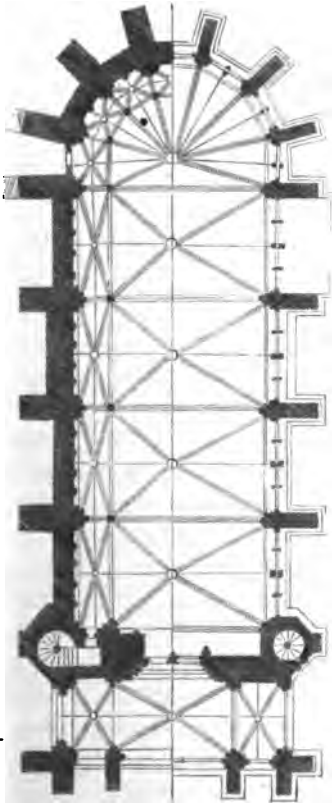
Ste. Chapelle zu Paris. Grundriss.
